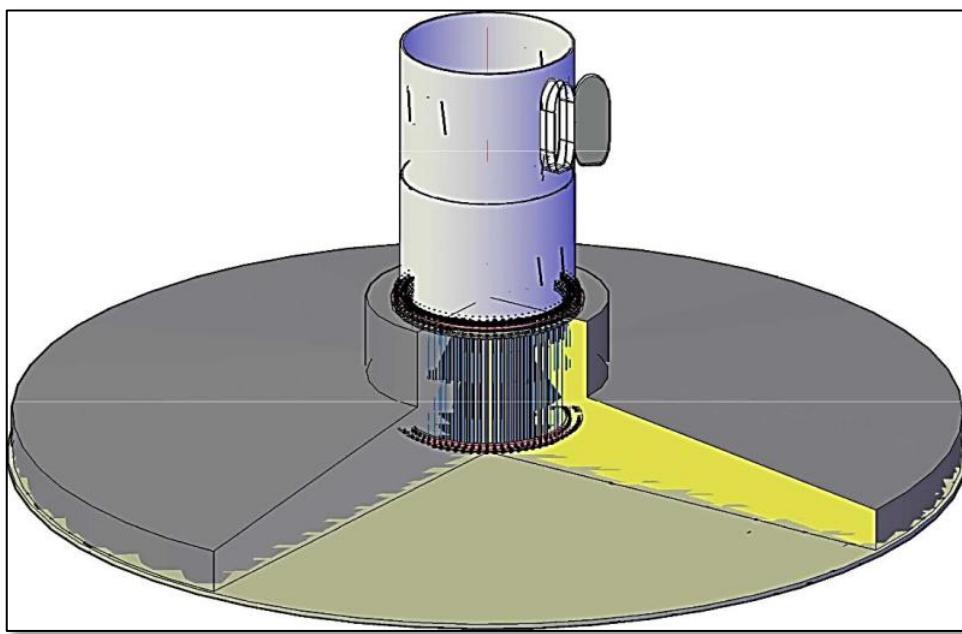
Общий вид фундамента ВЭУ1 и ВЭУ2
